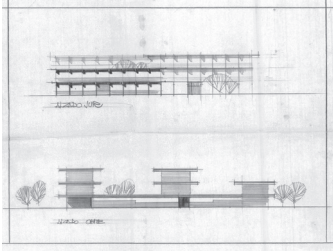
Anteproyecto de guardería y colegio de preescolar para la parroquia de santa Clara, Vigo, 1966. Alzados sur y oeste. Archivo José L. Varela Alén.
